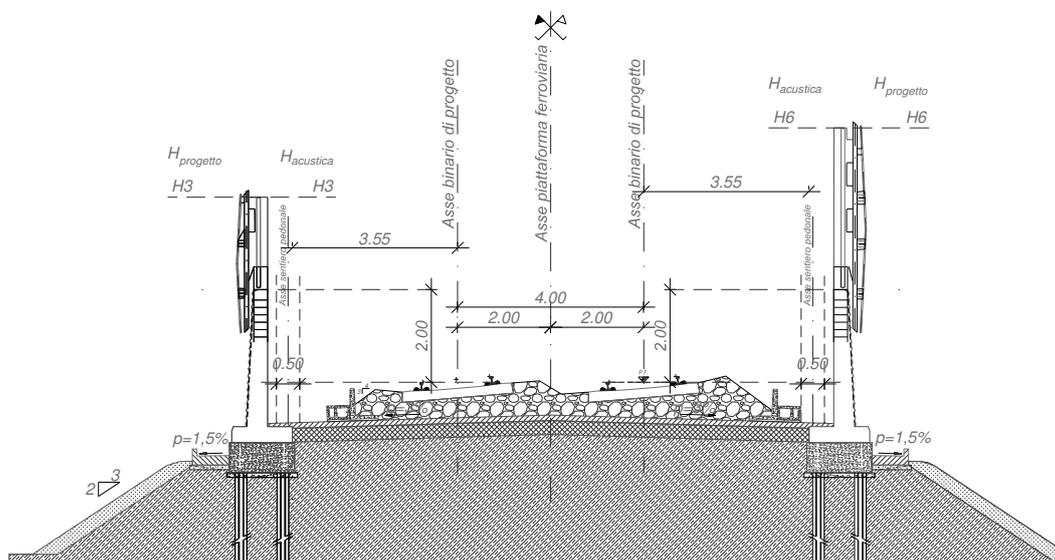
Sezione tipo tipologica BA "HS" rettificato con manufatto prefabbricato su rilevato
